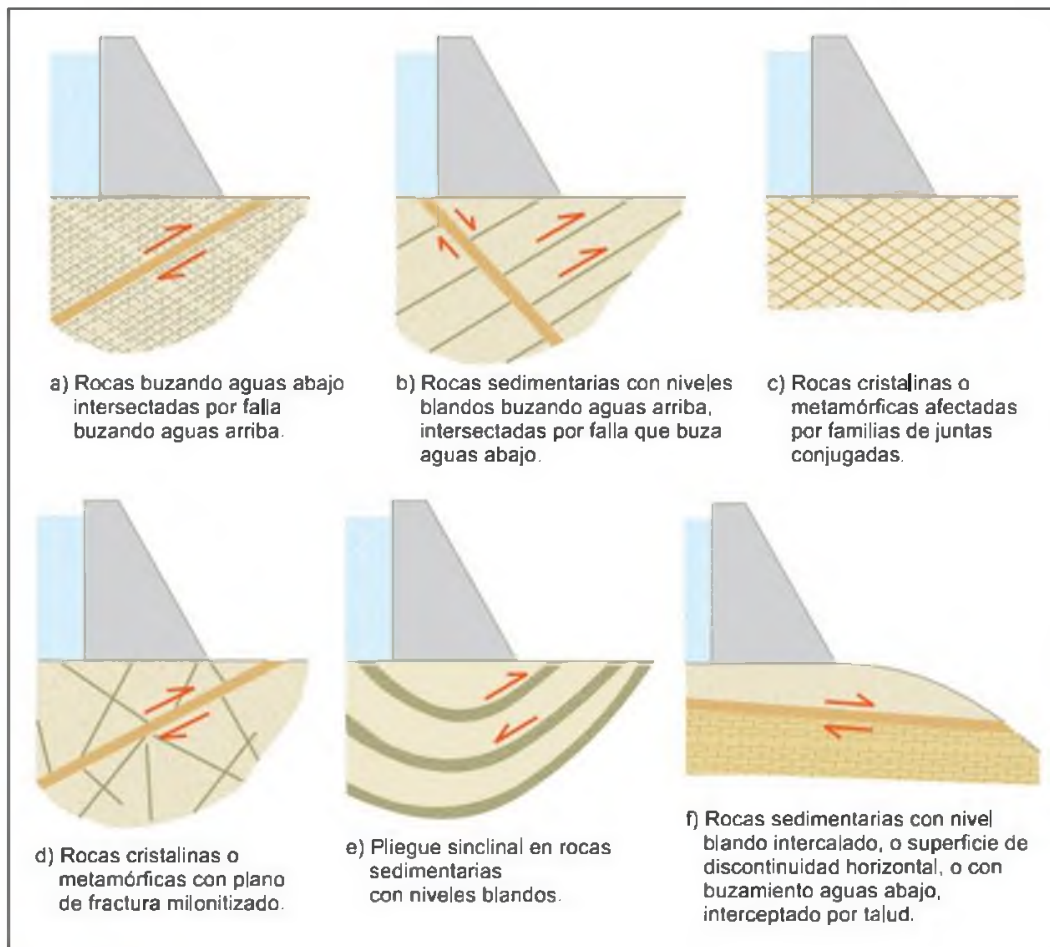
Condiciones geológicas favorables a la formación de roturas en la cimentación de presas de hormigón.
